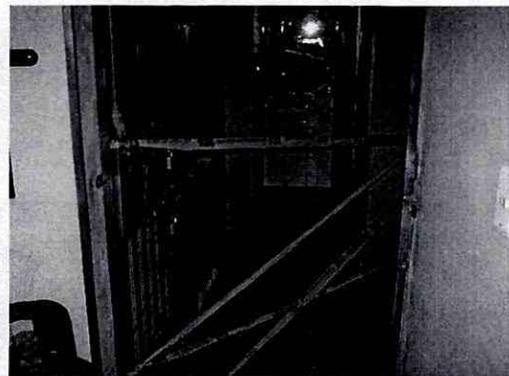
Se observa la zona de la vivienda de la Calle 29 Bis No. 5-34, que se quedo sin suelo de cimentación, zona que corresponde a un baño y a la cocina de la vivienda.
